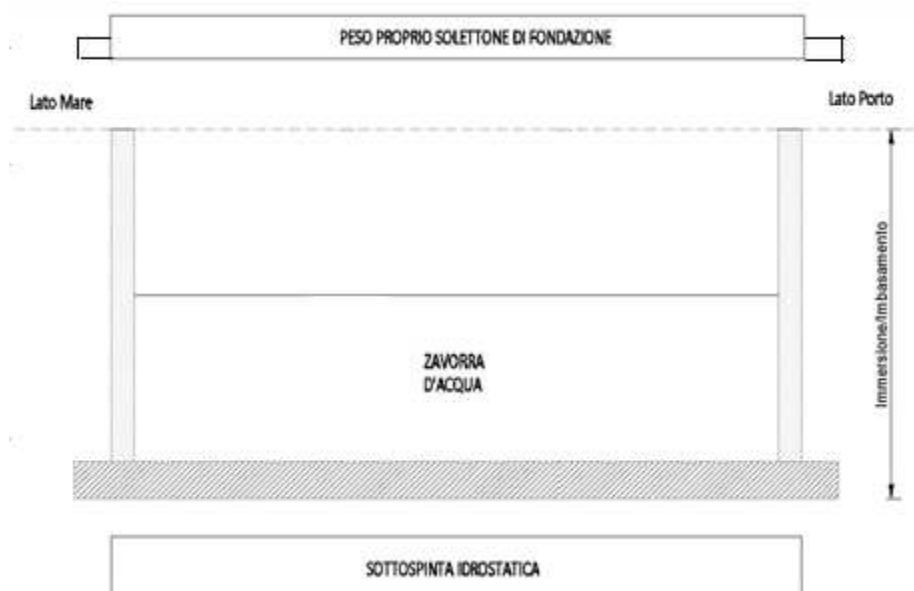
Solettone di fondazione. Schema di carico – Fase Provvisoria.
